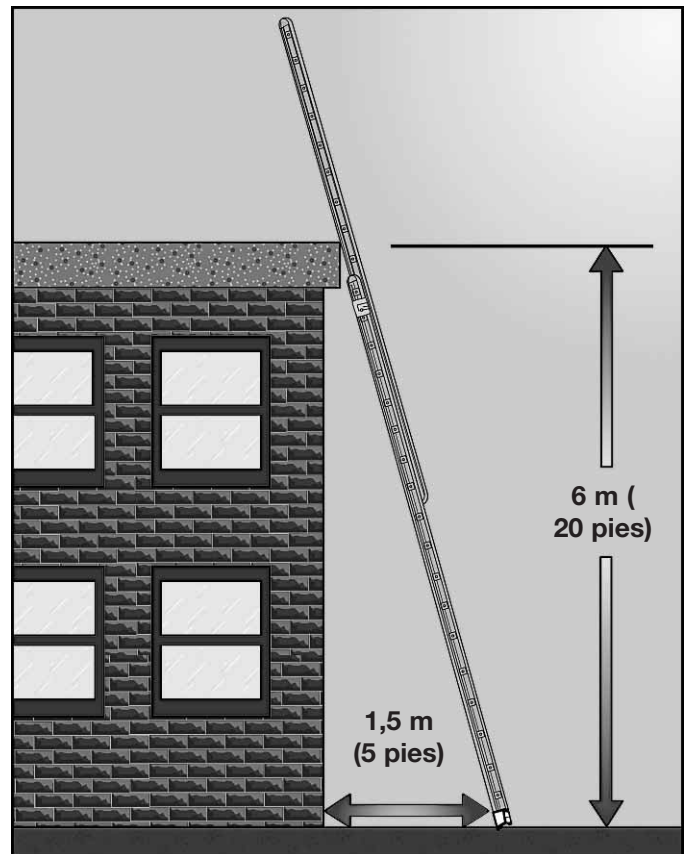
Una escala que se levanta 6 m (20 pies) debe tener la base a 1,5 m (5 pies) del edificio.
